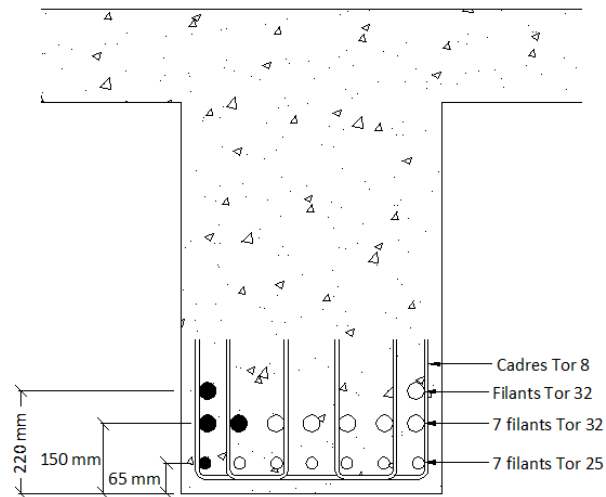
Ferrailage découvert sur la poutre Pt02 en travée 3
